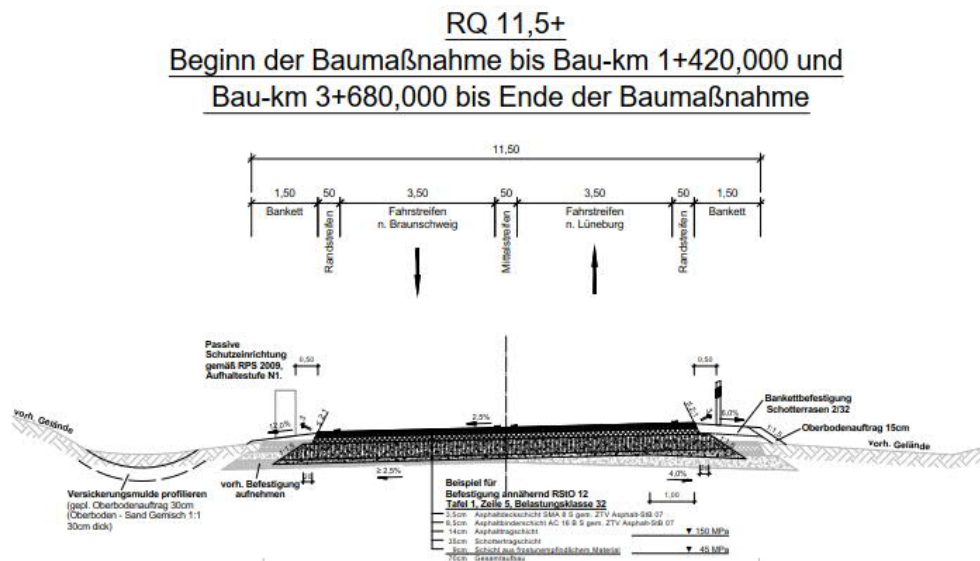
2-streifiger Straßenquerschnitt (nördlich des Knotens)
